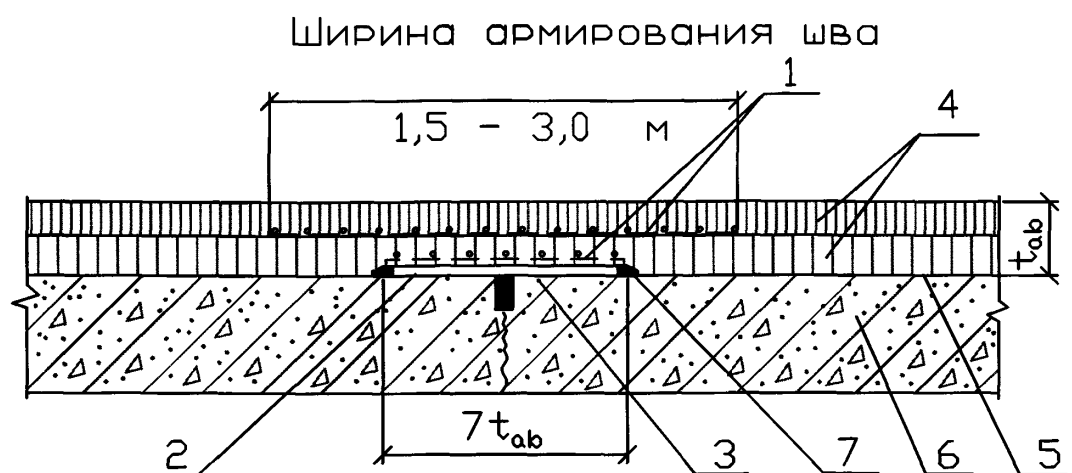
Конструкция армирования двухслойного асфальтобетона геосетками ССНП над швом жесткого покрытия
